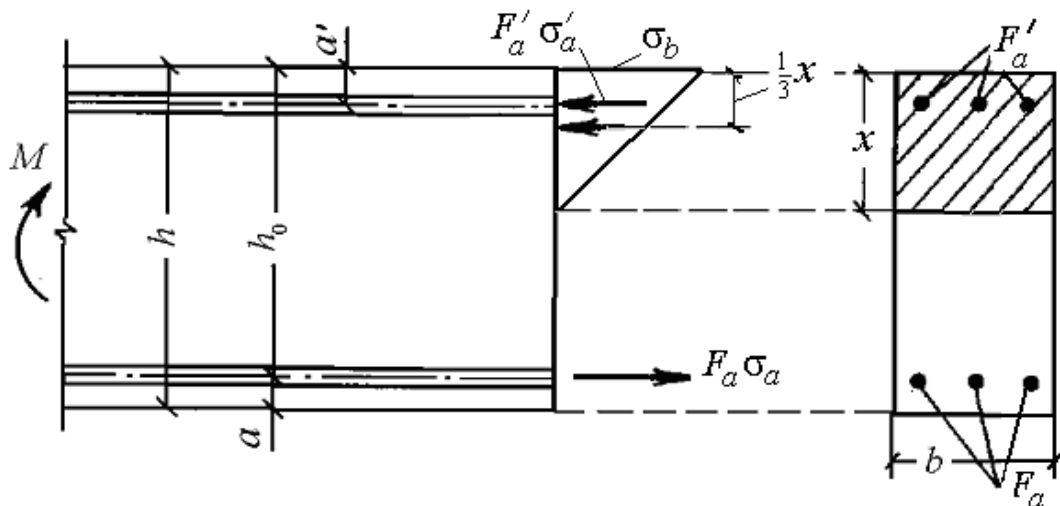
Нормальное сечение изгибаемой железобетонной балки с трещиной при двухслойном армировании:
